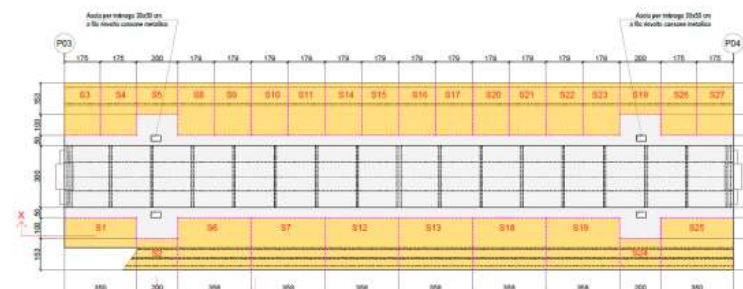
vista in pianta alleggerimento soletta a sbalzo impalcato
